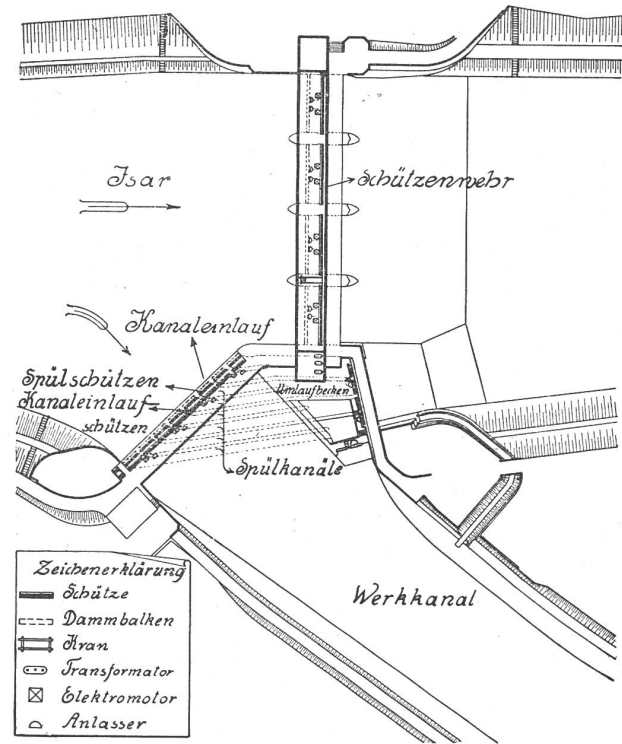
Isarwehr unterhalb München mit Einlaufbauwerk.
